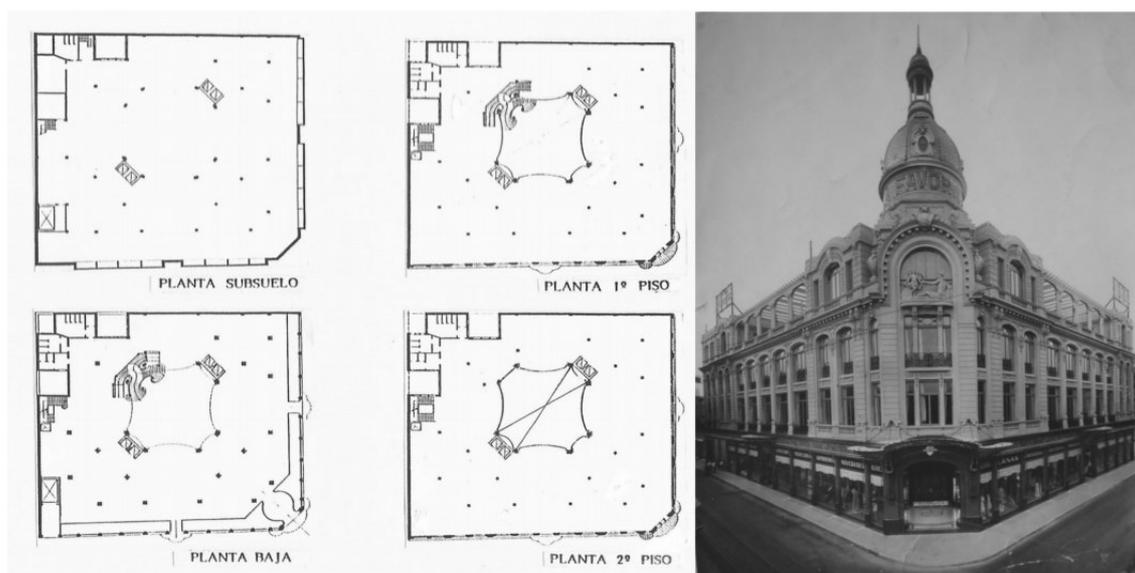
La Favorita, plantas y fachada. Fuente: VVAA, 1990: 55 y Archivo Candia.
